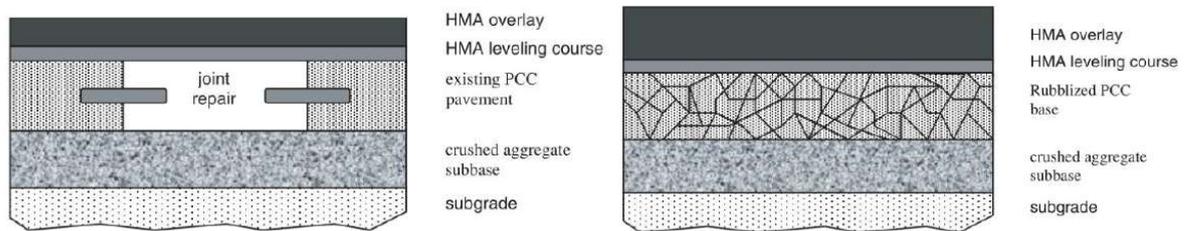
Anwendungsbereiche Asphaltüberbau Betondecke nach [35]
